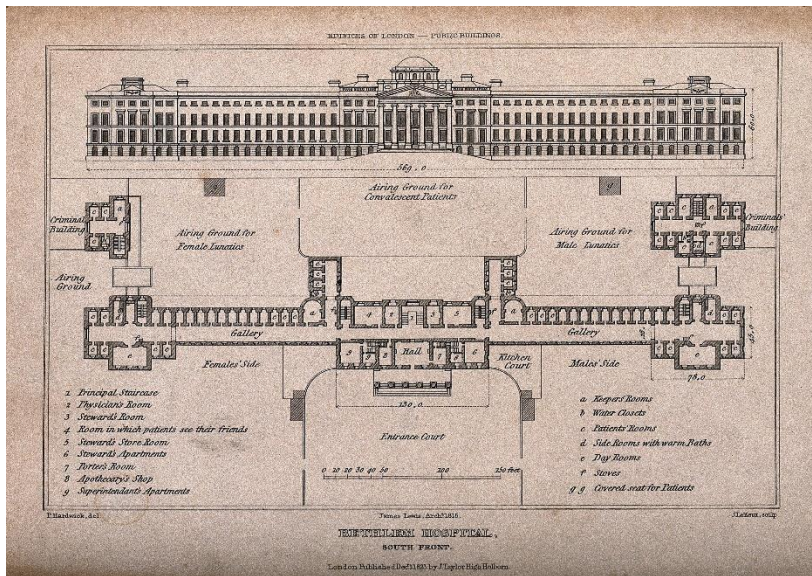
Sección y Planta de Hospital Bethlem, 1823.
